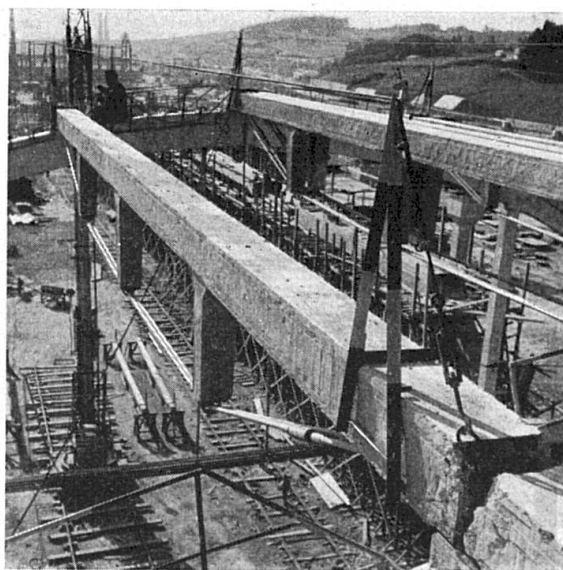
Assemblage des poutres longitudinales sur des arcs.
